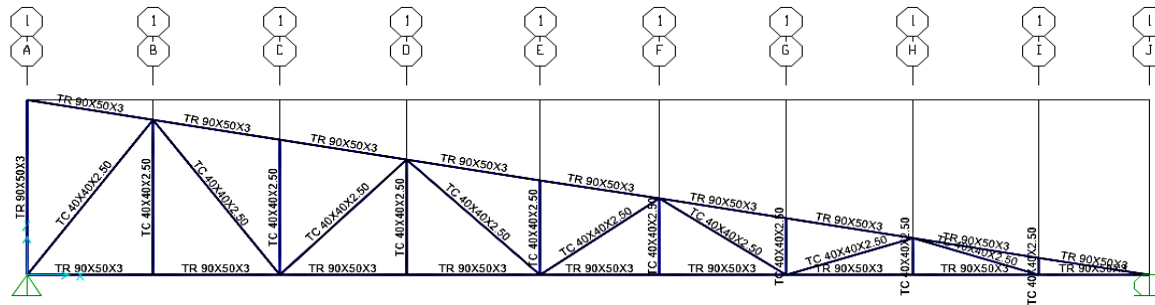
Modelo en SAP2000 de cercha tipo 3 para cubierta de la zona A. Fuente: Autor.
